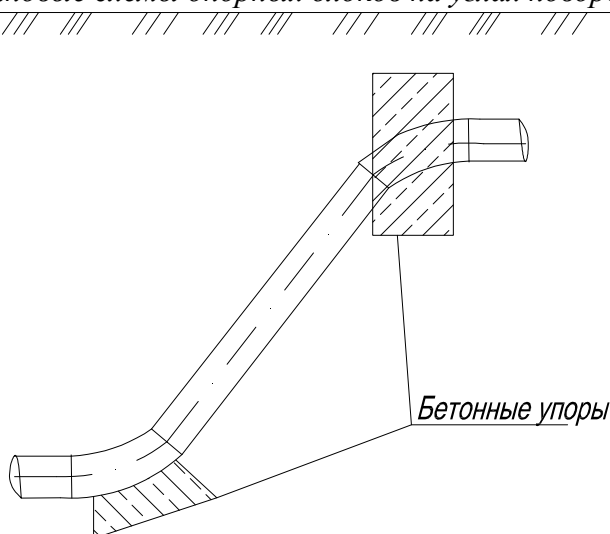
Типовая схема обустройства вертикального угла поворота опорными блоками. Бетонный упор необходимо опирать на грунт с ненарушенной структурой стенки, его лицевая поверхность должна быть перпендикулярна направлению, а центр на линии действия осевой силы.
